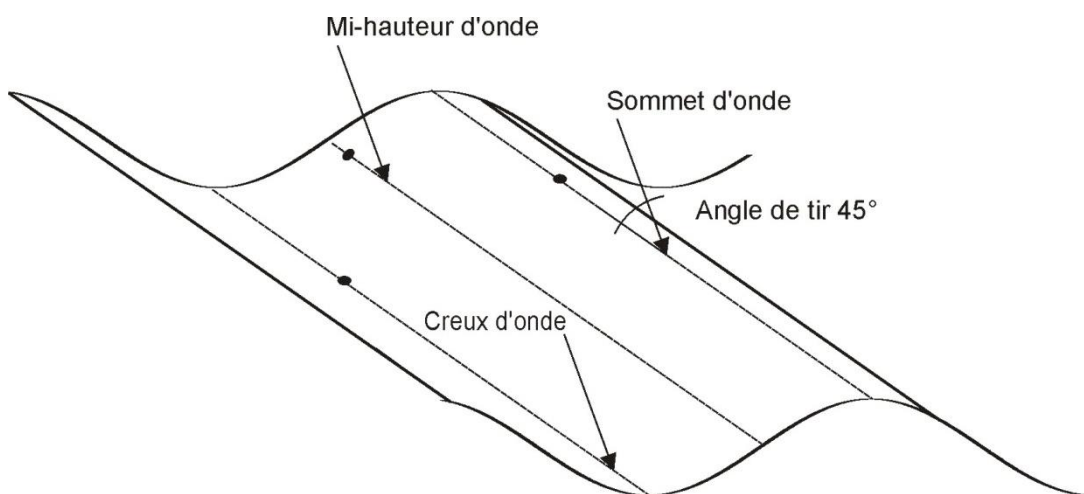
Points d'impact et angle de tir pour une plaque ou une ardoise en fibres-ciment profilée de façade avec l'axe du profil en direction horizontale ou diagonale (dimensions en millimètres).
